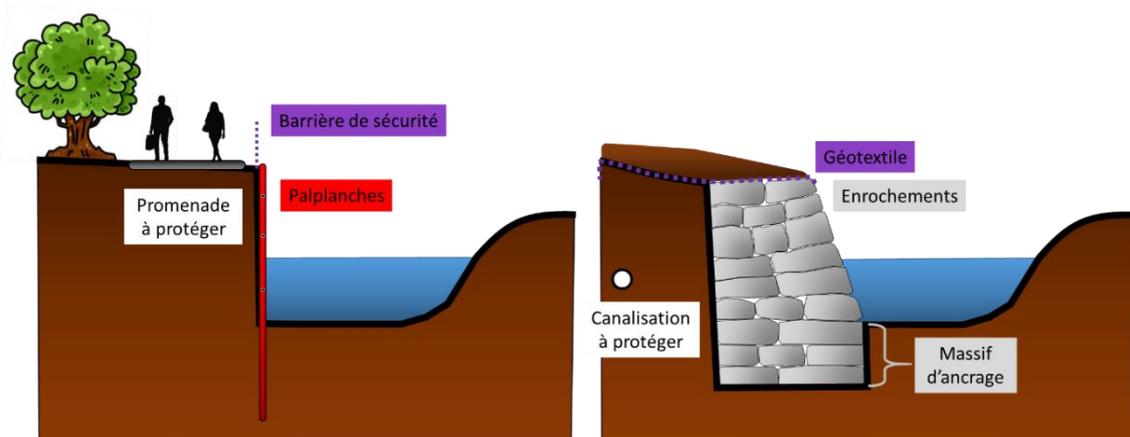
Exemples de renforcement de berges par techniques « dures »
